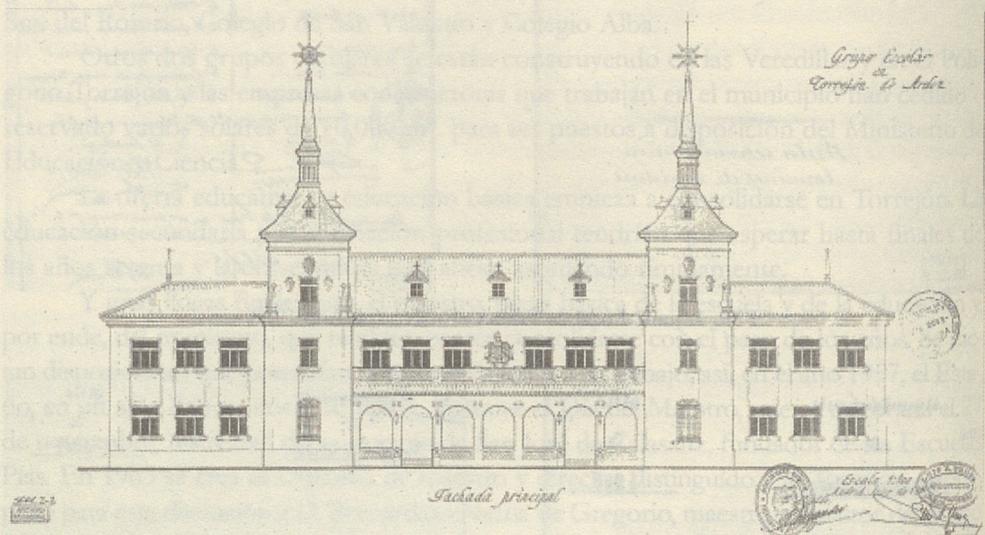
Proyecto de construcción del Grupo Escolar «El Buen Gobernador». Años 1945-1947.
